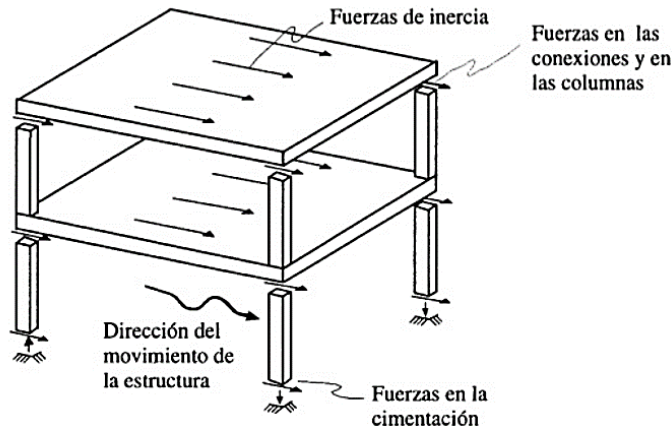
Flujo de fuerzas en la estructura debido a la vibración, (Bazán y Meli, 2014).
